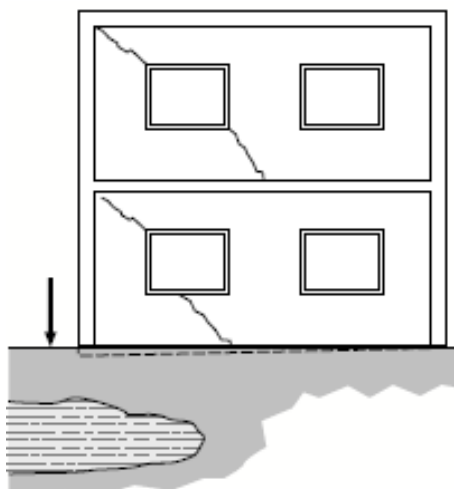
Ascensão das fissuras de recalque pelos pavimentos.
